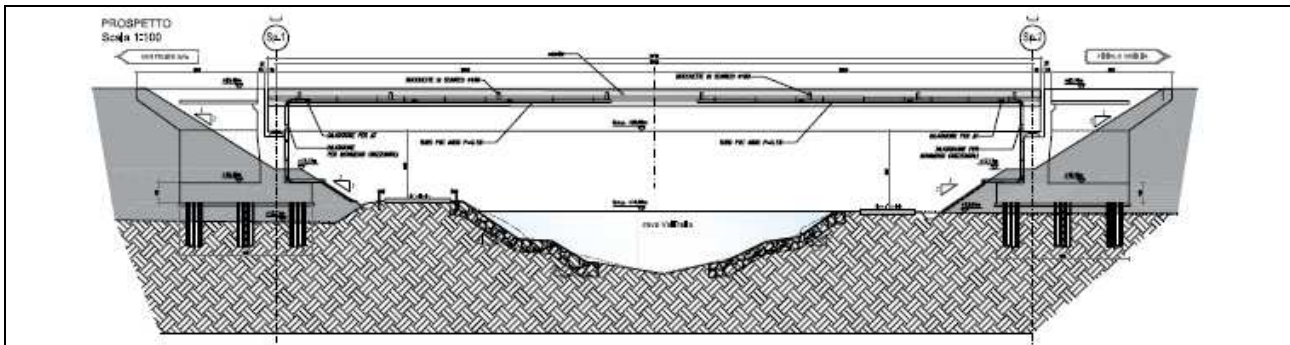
PLANIMETRIA E PROSPETTO PONTE SUL VALLICELLA - CPO03
